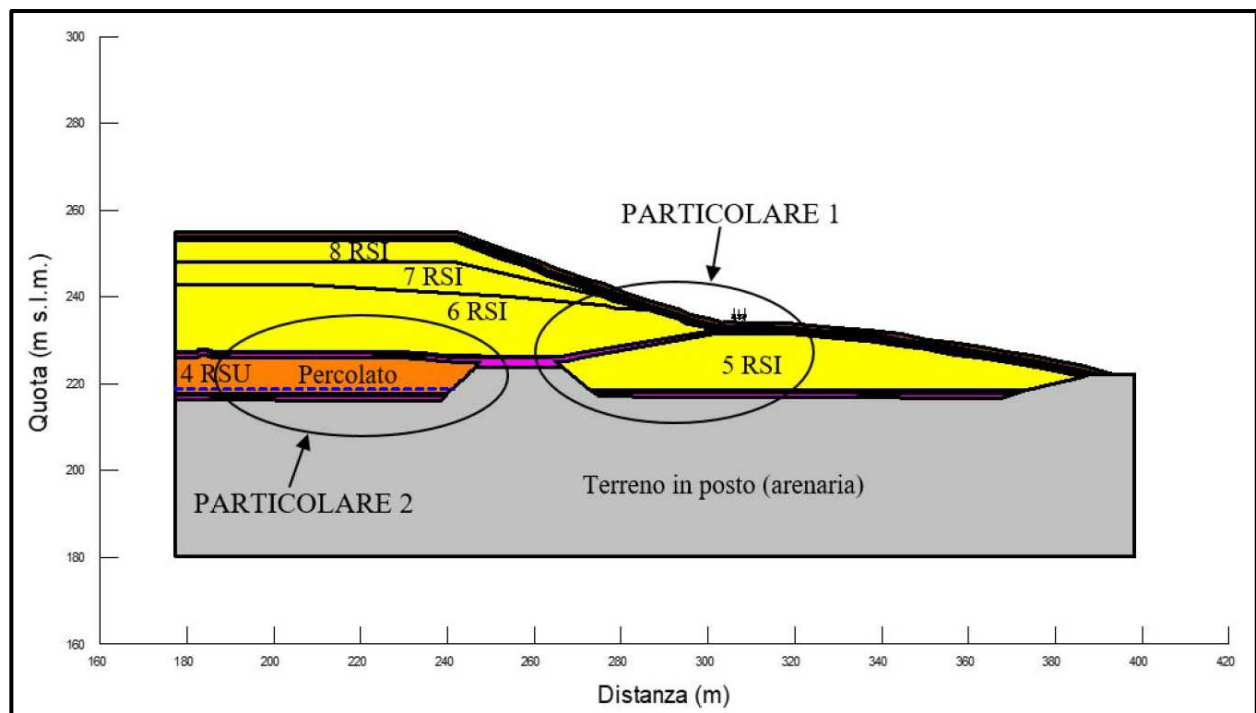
/IV – Sezione A-A' – Sponda sud-ovest
